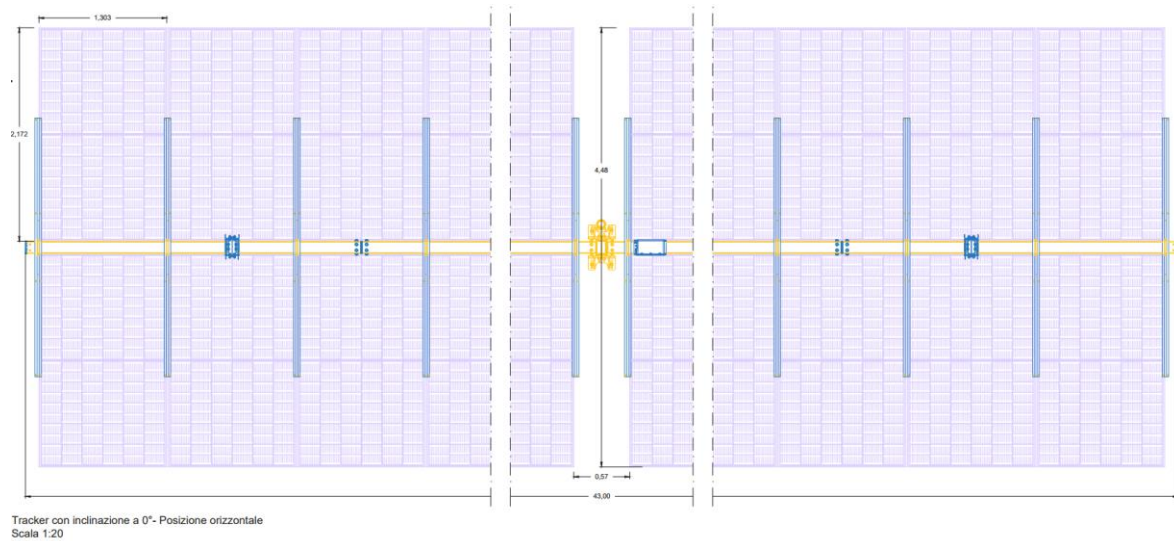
Schema architettonico struttura con 32x2 pannelli
